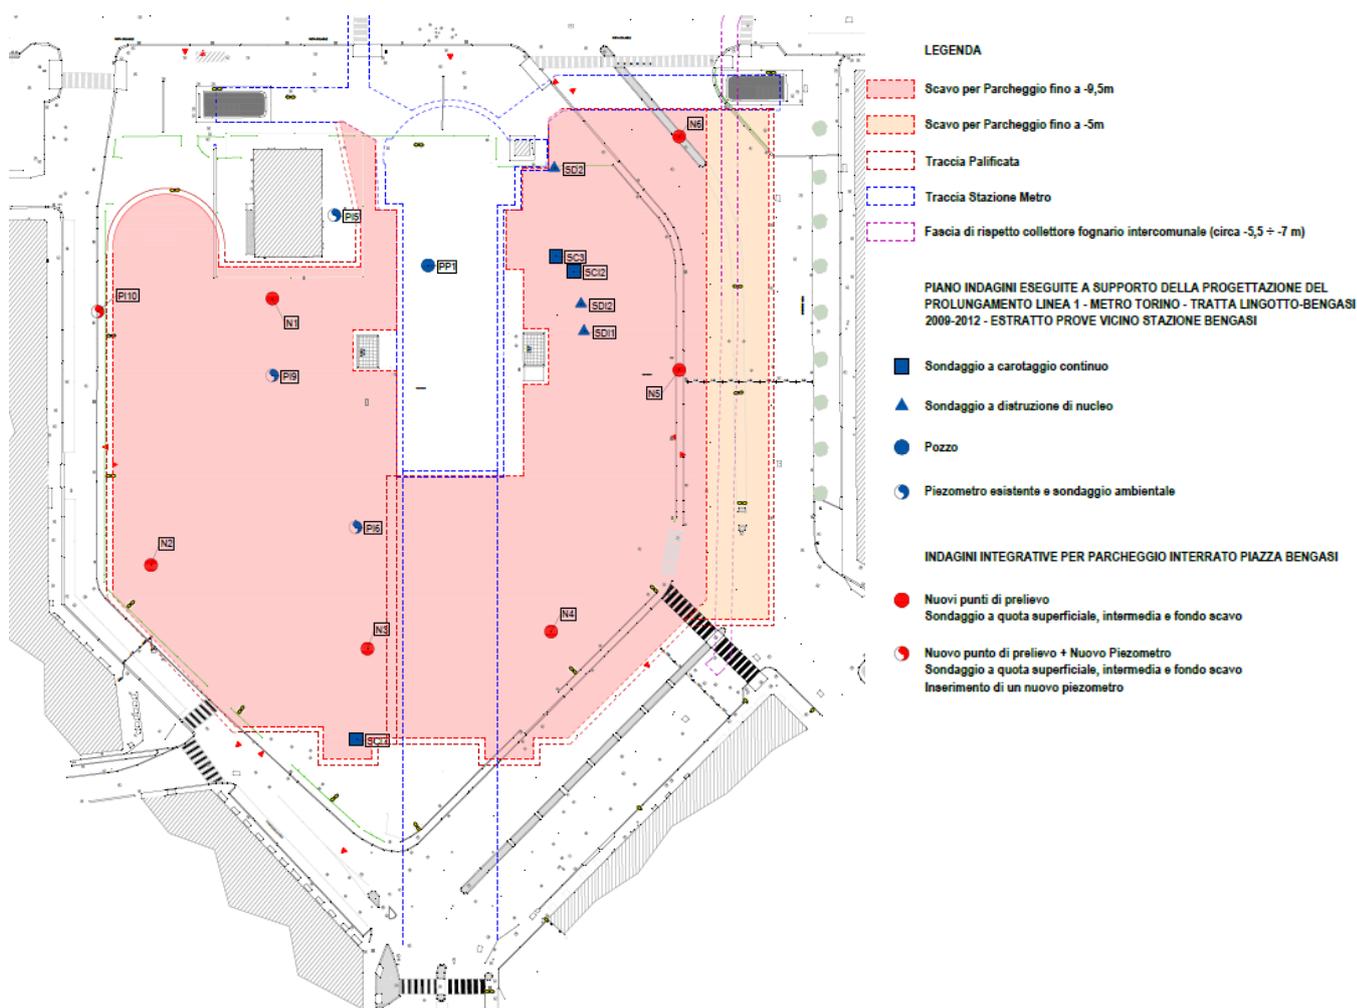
Planimetria generale del piano di caratterizzazione ambientale
